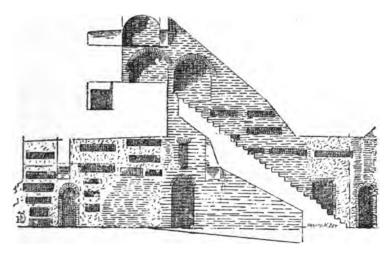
Coupe de l'escalier et de l'entrée actuelle du cimetière de Calliste.
